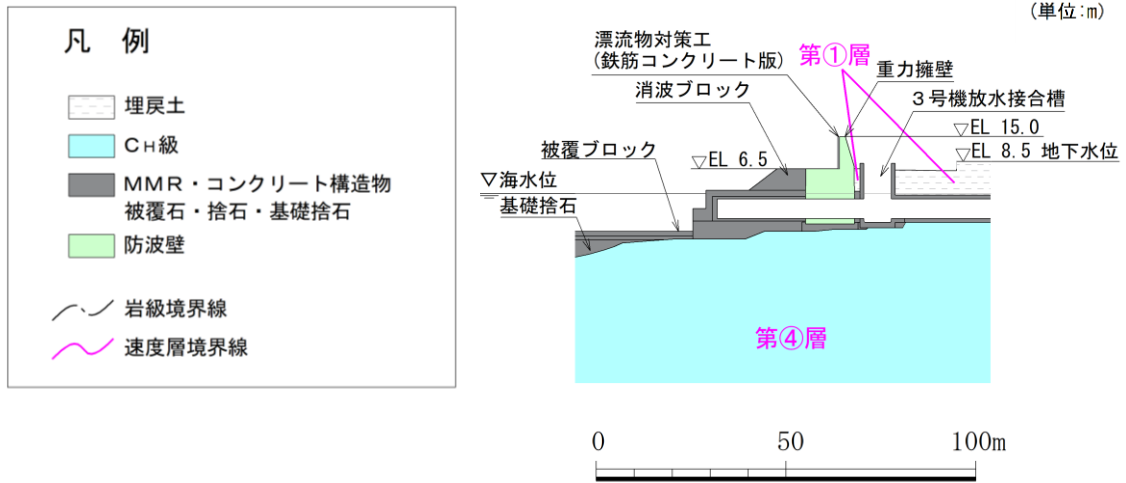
防波壁（波返重力擁壁）の横断面図（③-③断面）
